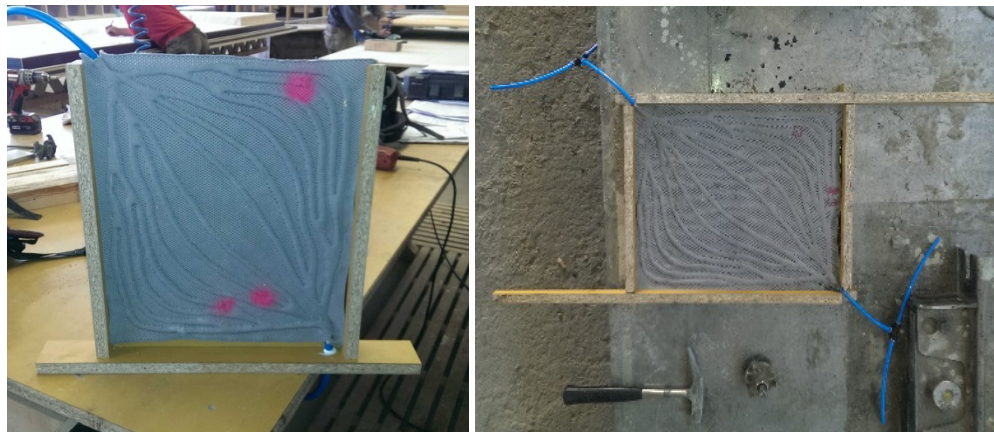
Einfache Schalung mit Textil (links); Schläuche (blau) für das Entleeren nach dem Betonieren (rechts)
